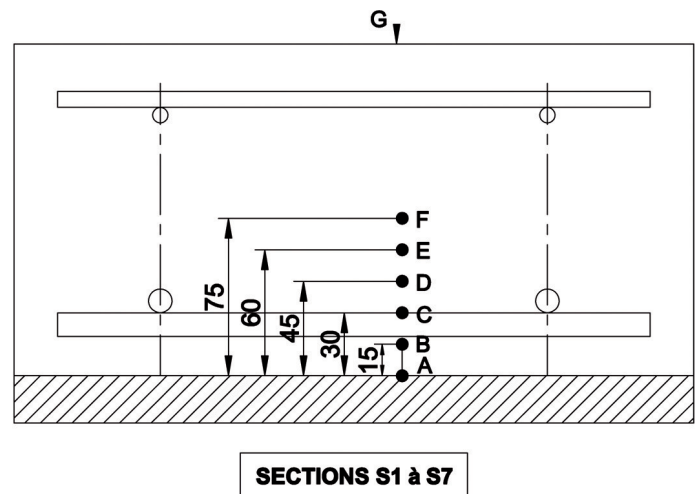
Positions des thermocouples dans l'épaisseur de la dalle béton (vue en coupe)
